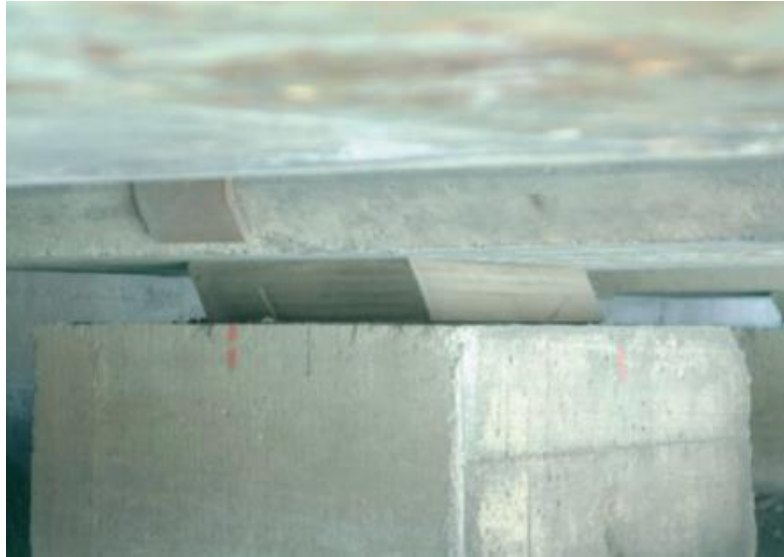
27: Desplazamiento en apoyo de neopreno (Ministerio de Fomento, 2009)
